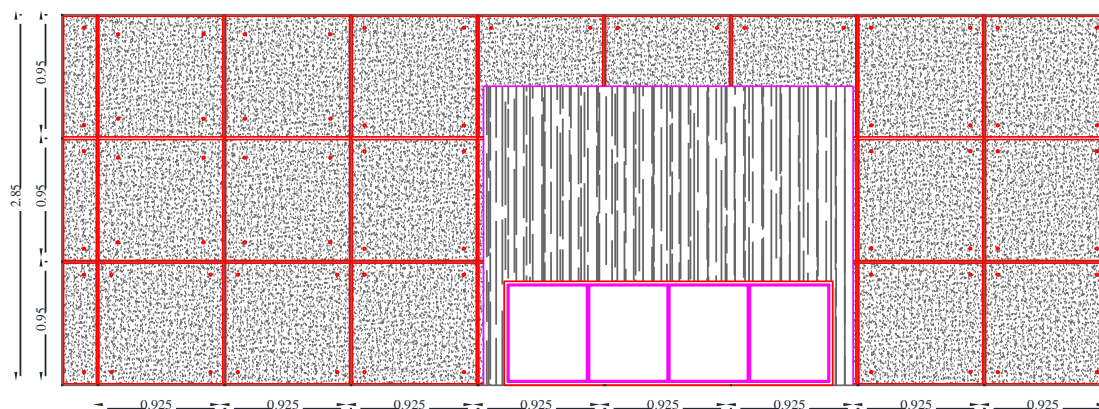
Primeras propuestas para este muro, se había pensado hacerlas de cempañel en acabado madera.
